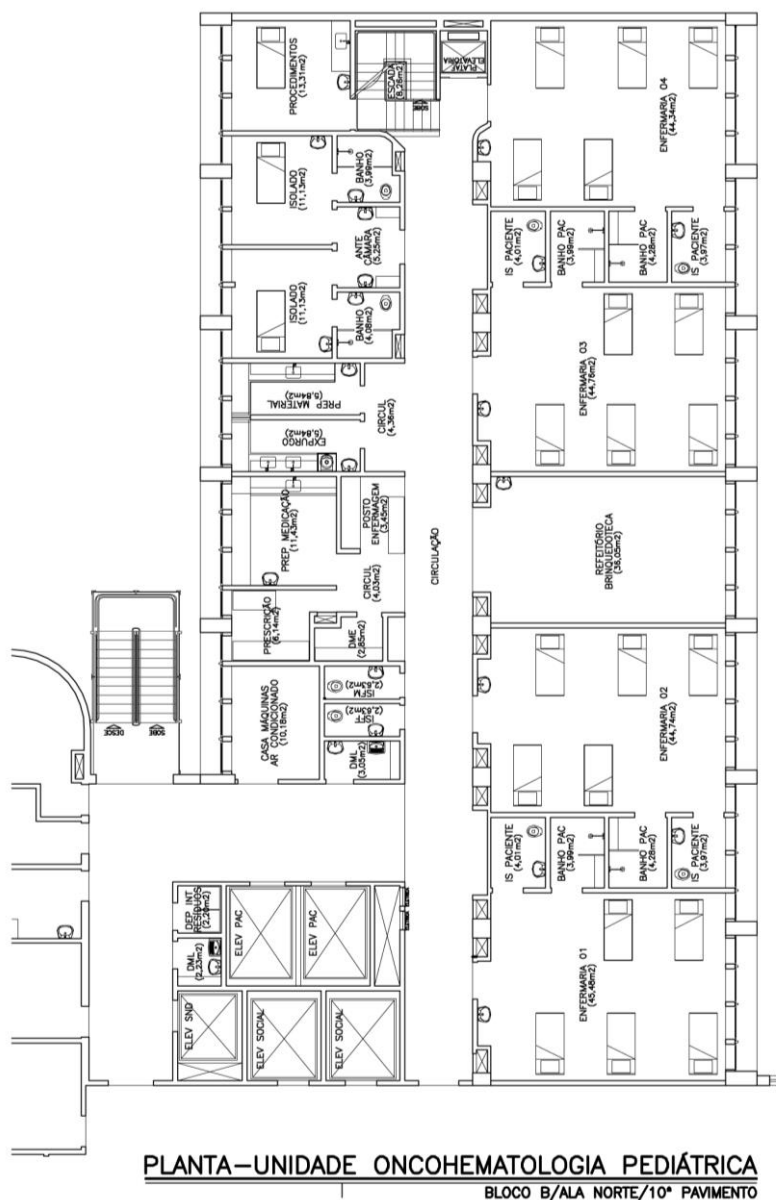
Planta da Unidade de Internação da Oncohematologia Pediátrica no 10º pavimento.
